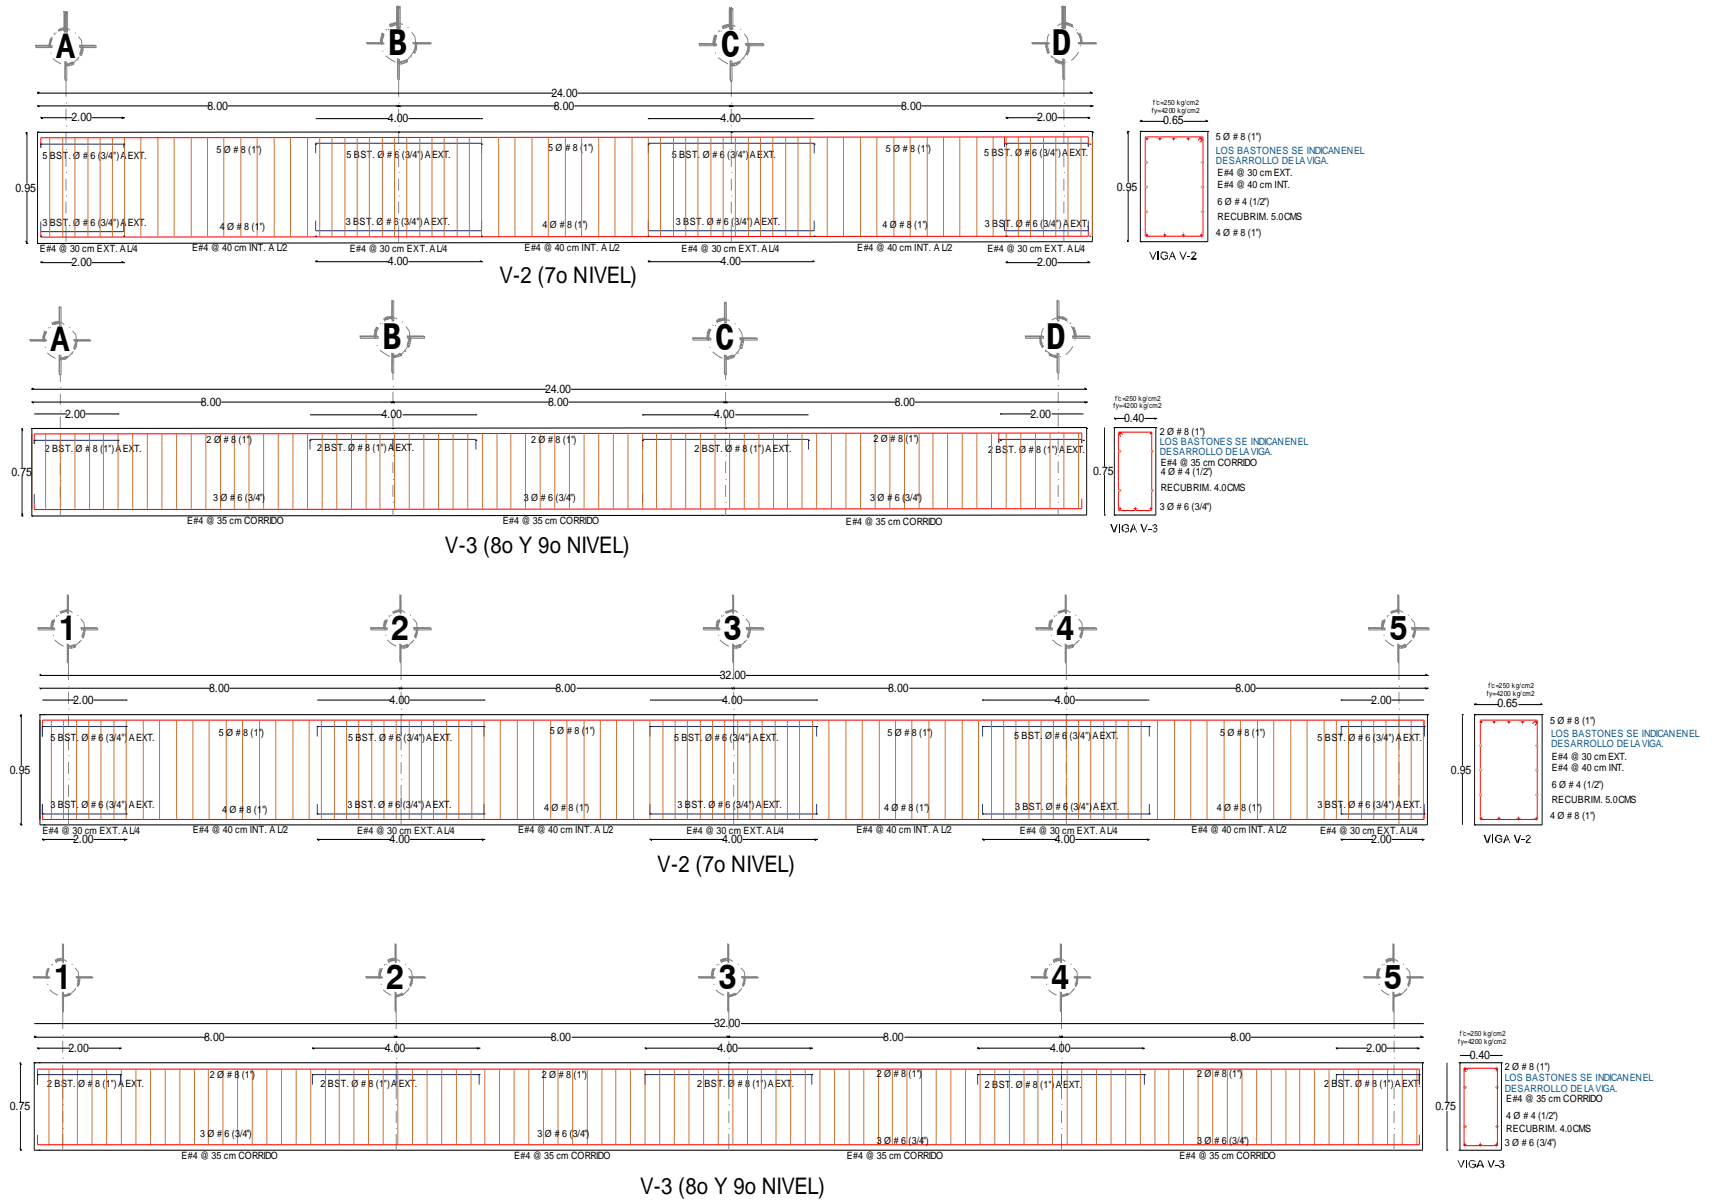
Detallado de armado de vigas de edificio de 9 niveles con base a la hipótesis de las NTCC-17 (continuación).
